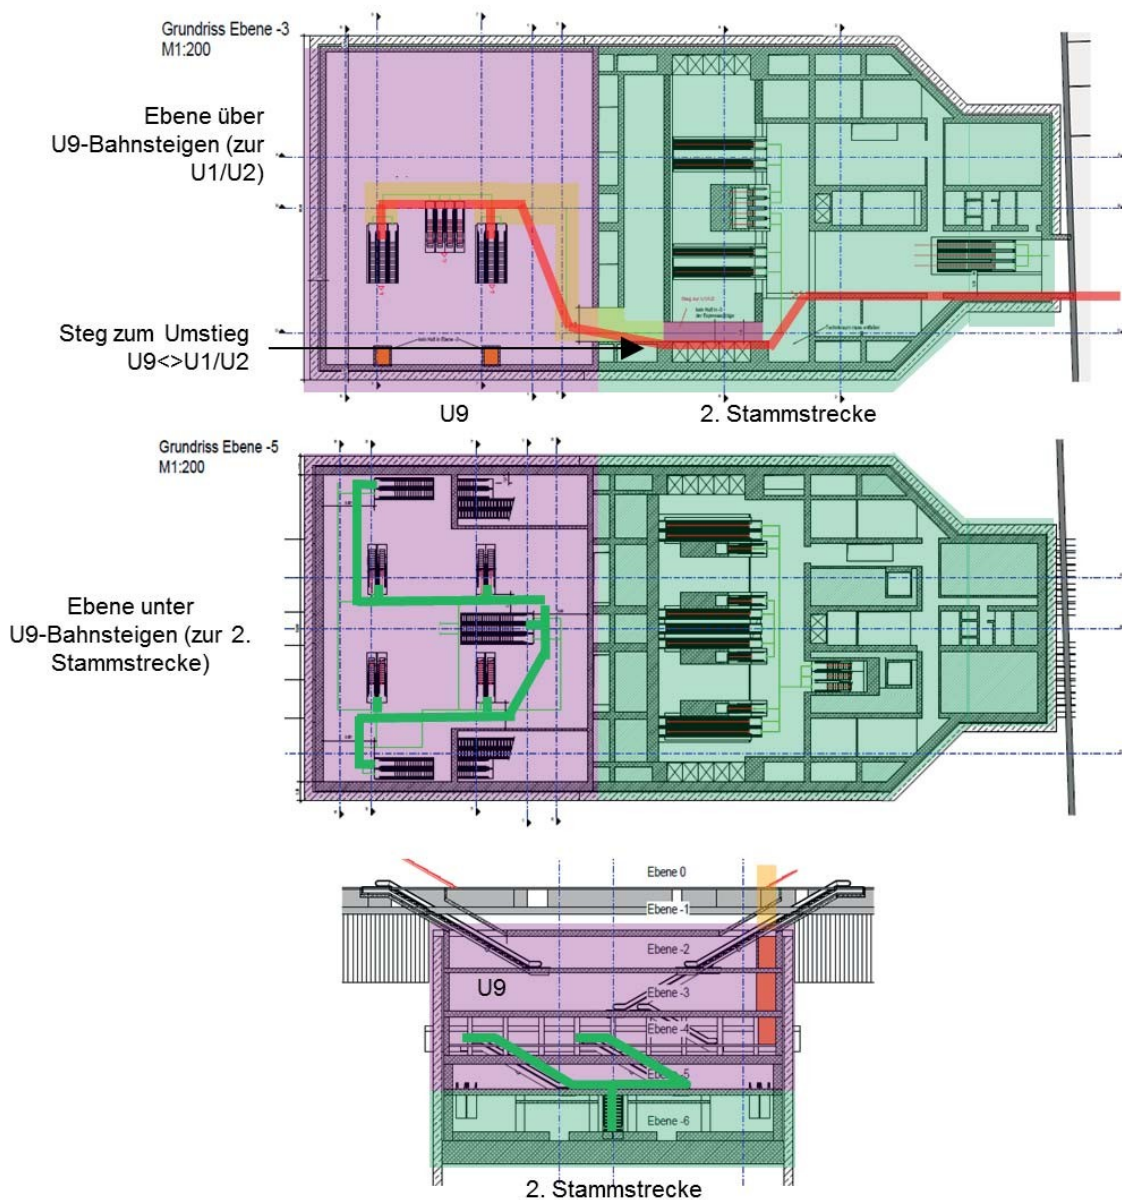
Grundrisse und Querschnitt des Baukörpers inkl. Kennzeichnung der Umsteigebeziehungen
